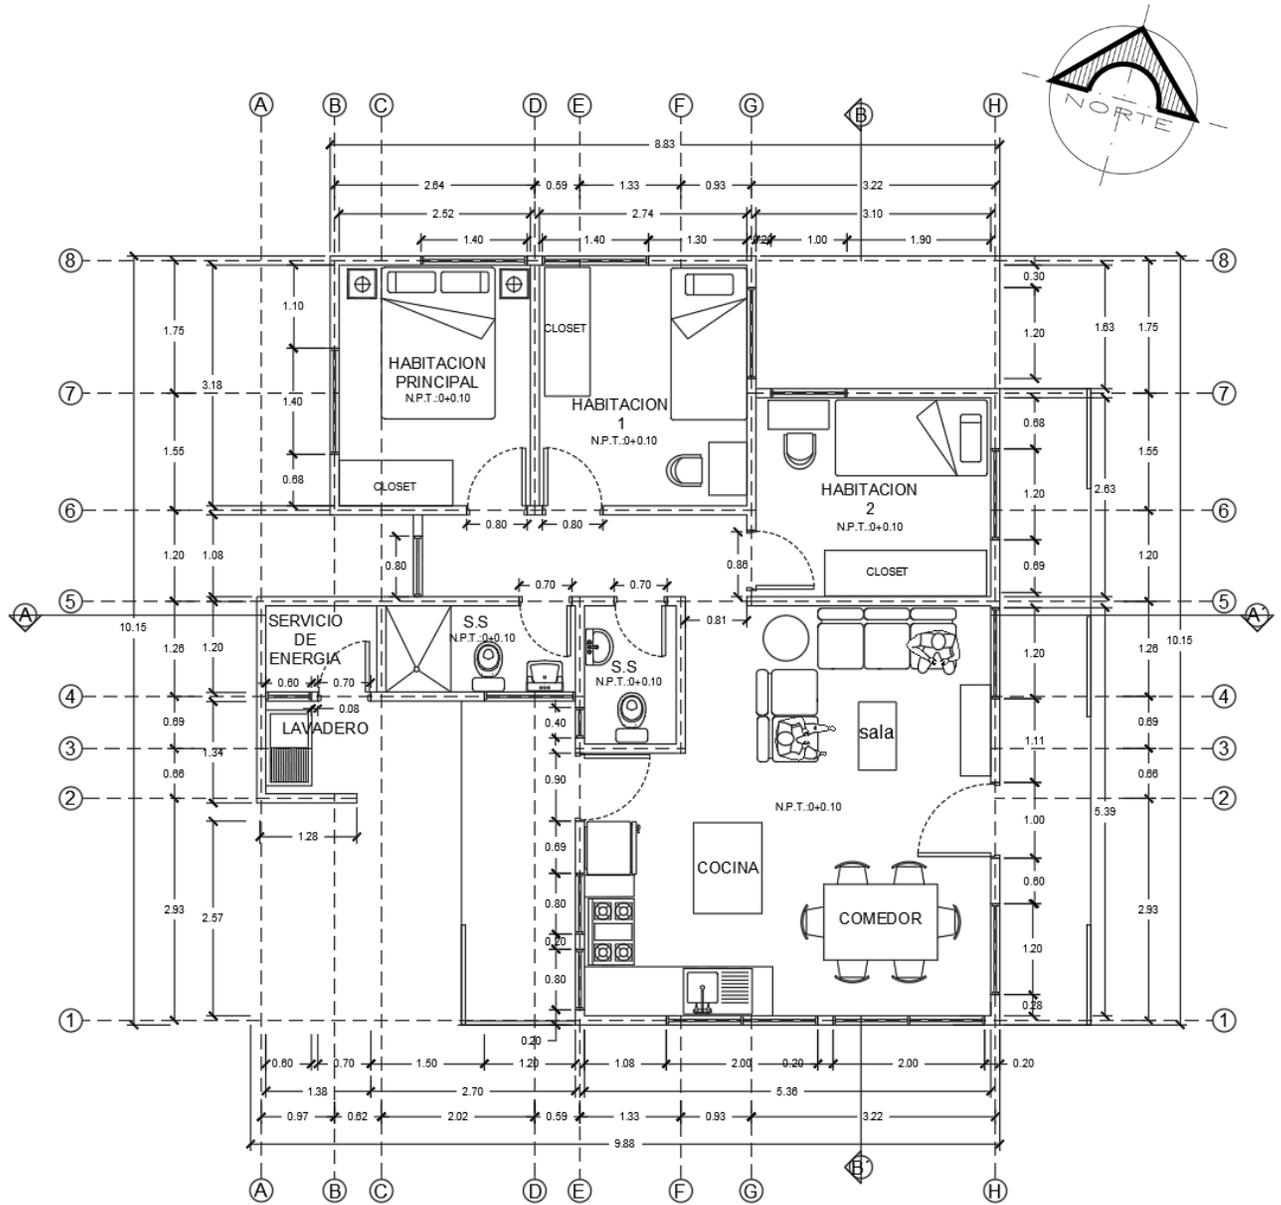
Planta arquitectónica de vivienda bioclimática sostenible
